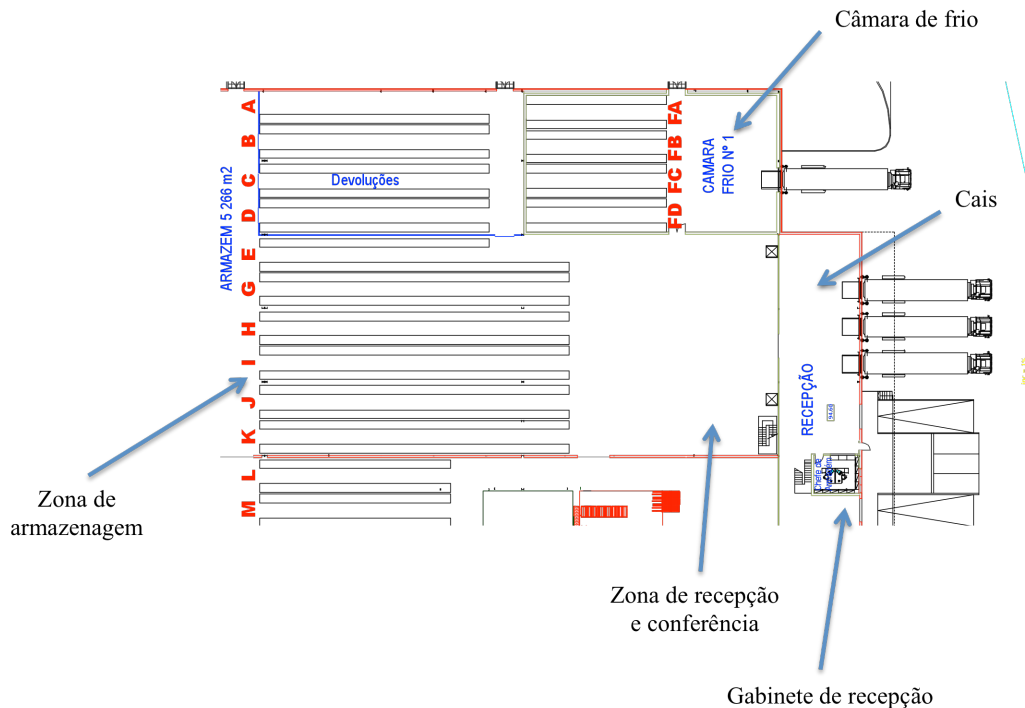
Pormenor da planta do cais, gabinete de recepção, zona de recepção, zona de frio e um bloco de racks
